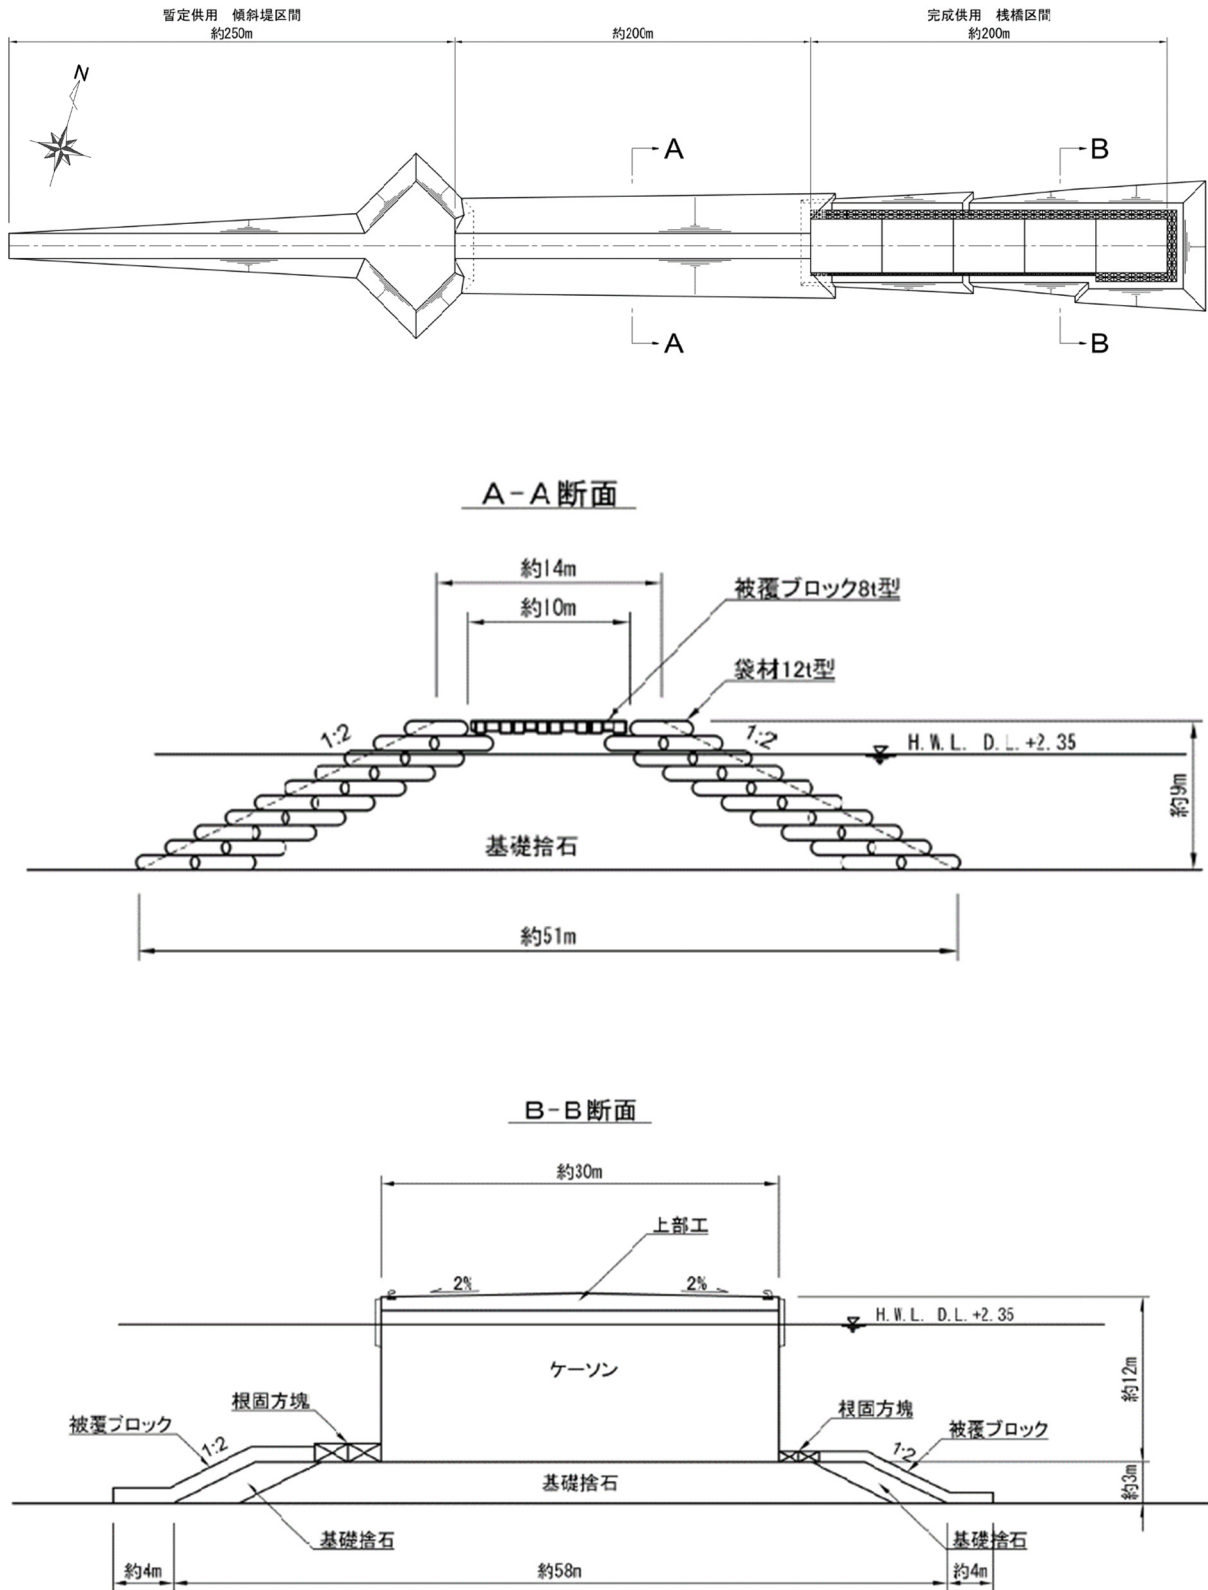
(2) 仮設栈橋の平面図及び標準断面
